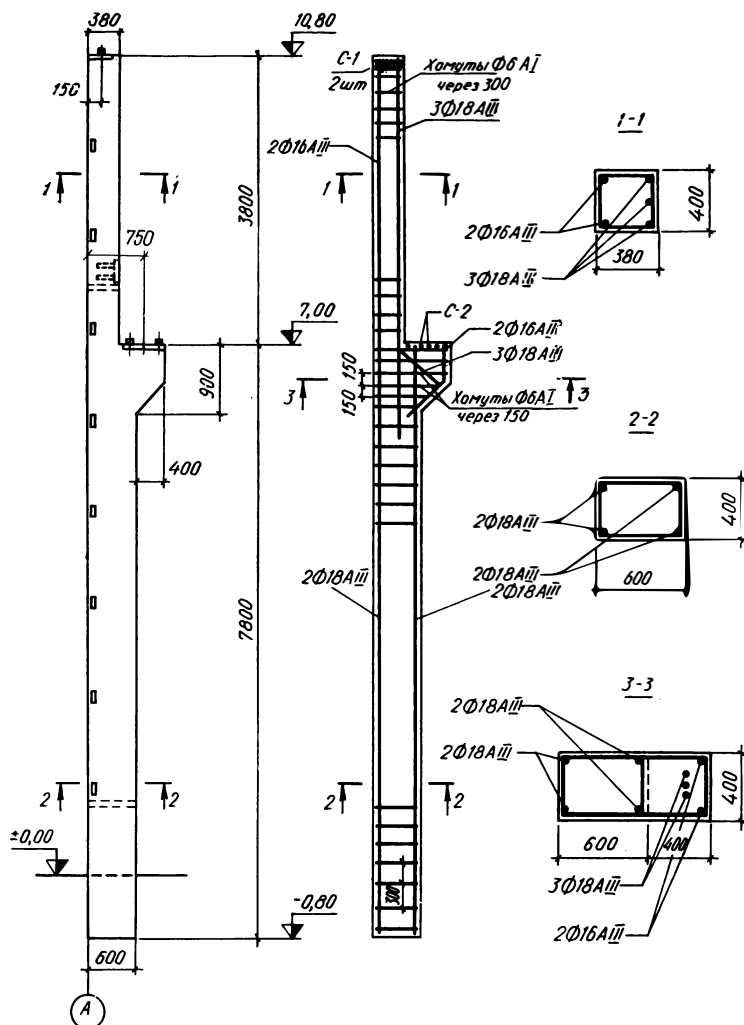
Конструкция и армирование колонны крайнего ряда.
